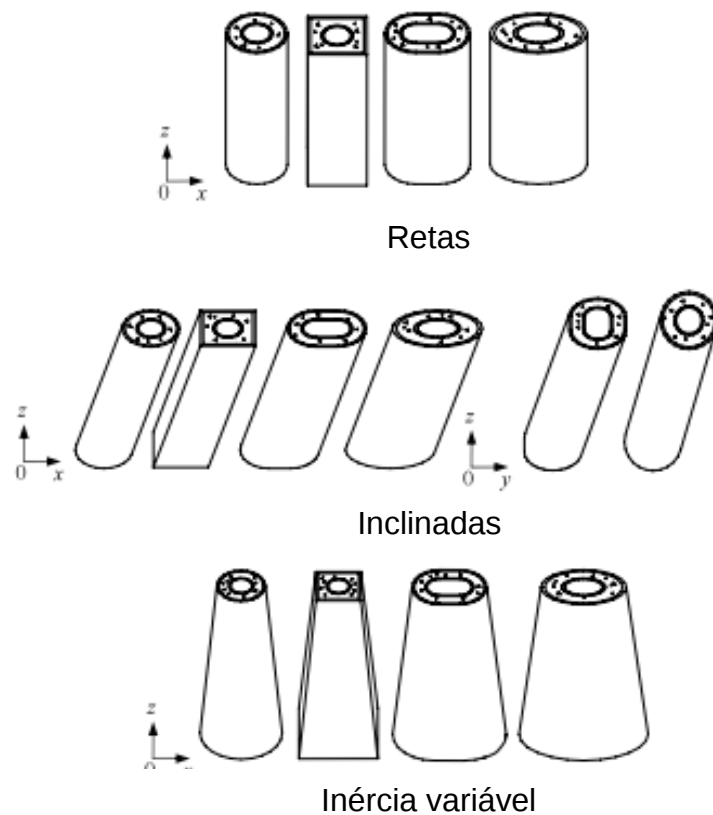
Vista Esquemática das seções *CFDST* ensaiadas [10]
